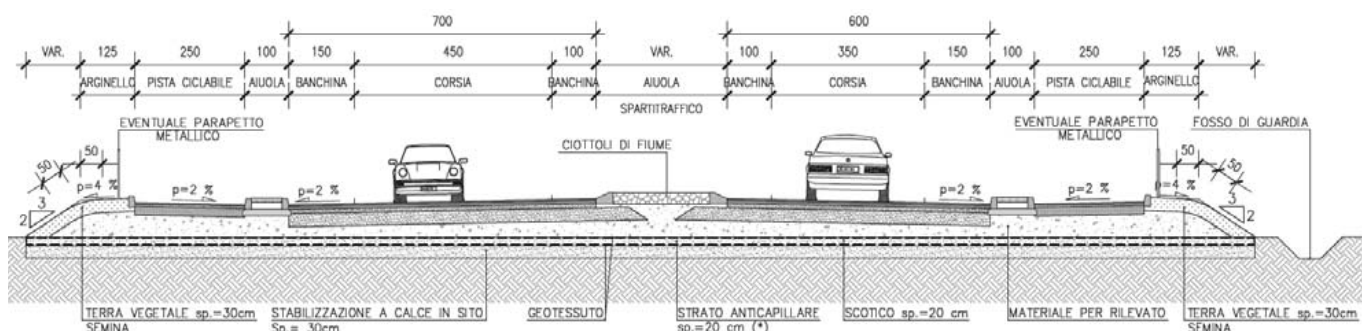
Sezione tipo in rotonda con pista ciclabile
